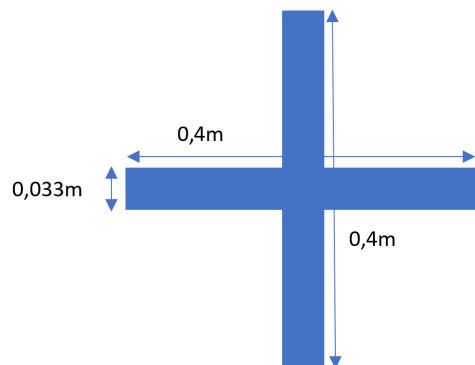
Dimensions de la section minimale d'une colonne
